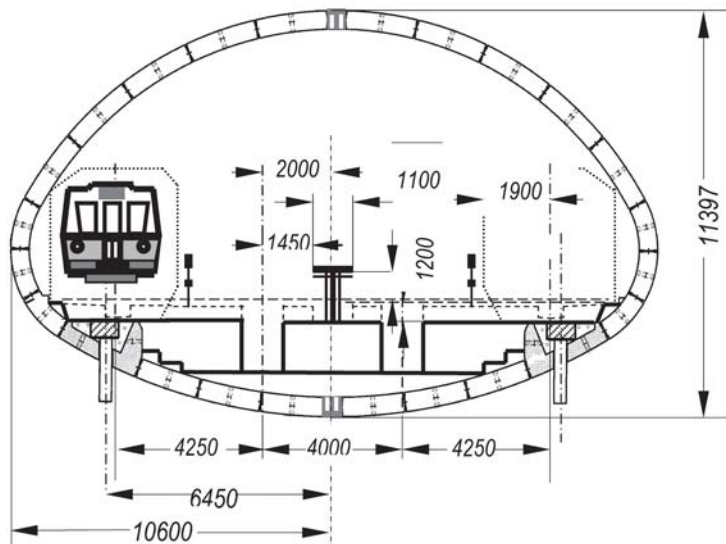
Поперечний переріз по щитовому приміщенню СТП
